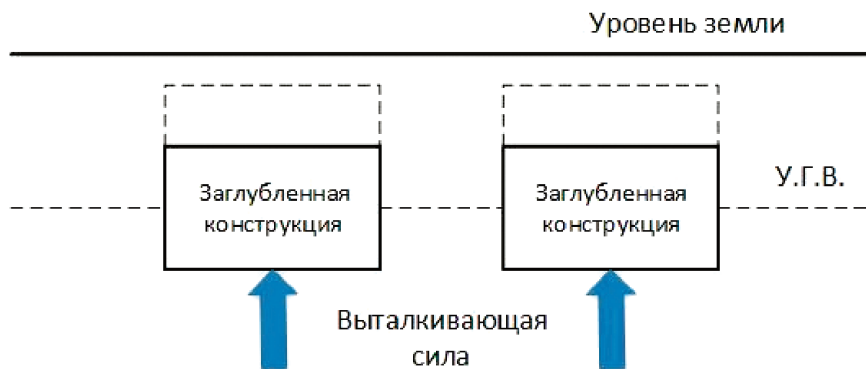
Схема действия выталкивающей силы на конструкции, заглубленные в грунт ниже уровня грунтовых вод
